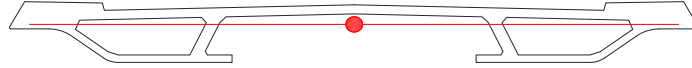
Seção principal do tabuleiro da ponte sobre o Rio Arade (Preta) e viga definida com as propriedades da seção e barras de ligação até o ponto de ancoragem dos cabos no tabuleiro (Vermelho)
